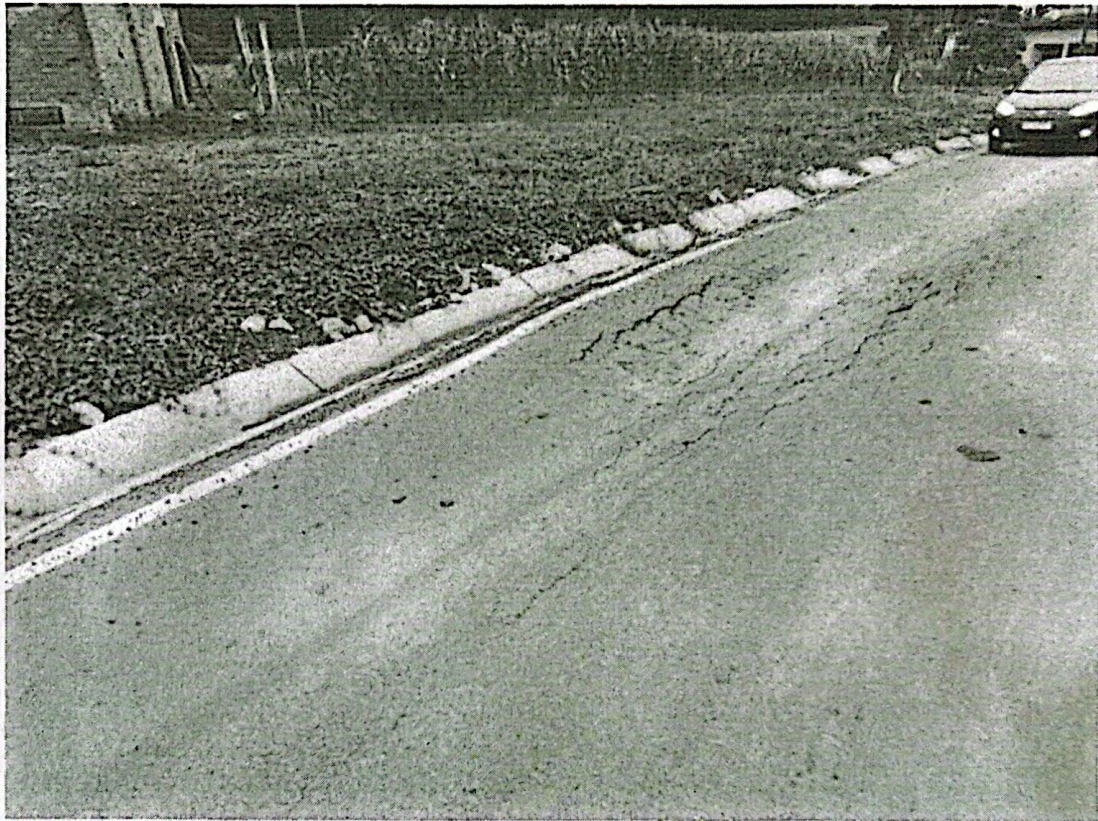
DESLOCAMENTO LATERAL E REBAIXAMENTO DA PISTA.
